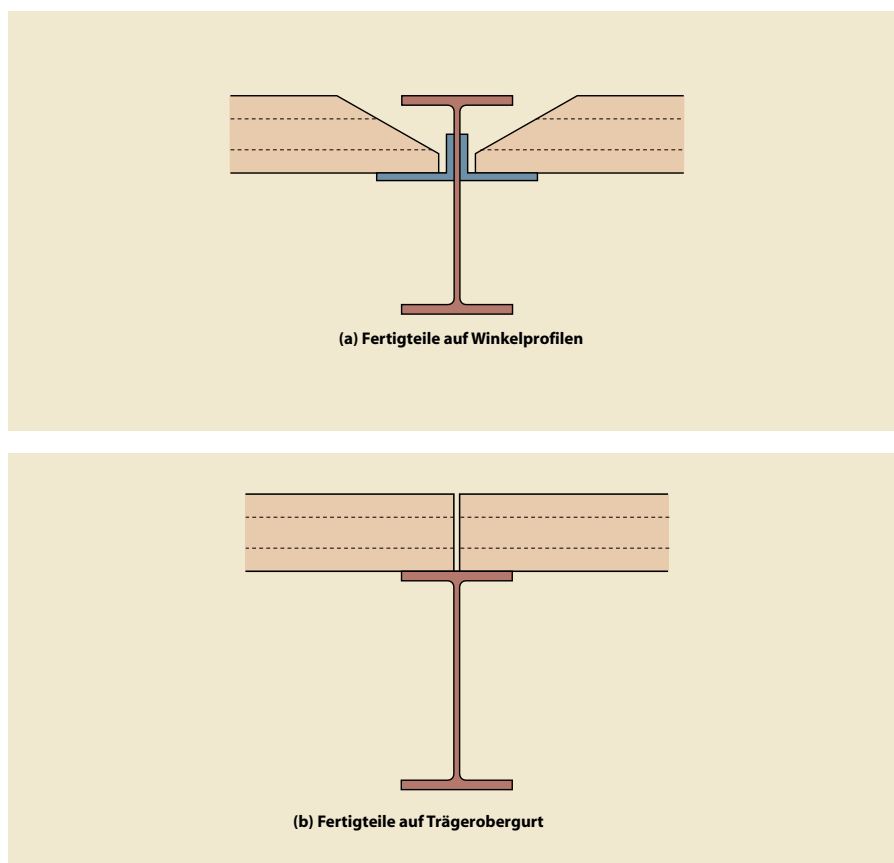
Deckenkonstruktion mit Betonfertigteilen und Stahlträgern ohne Verbundwirkung
